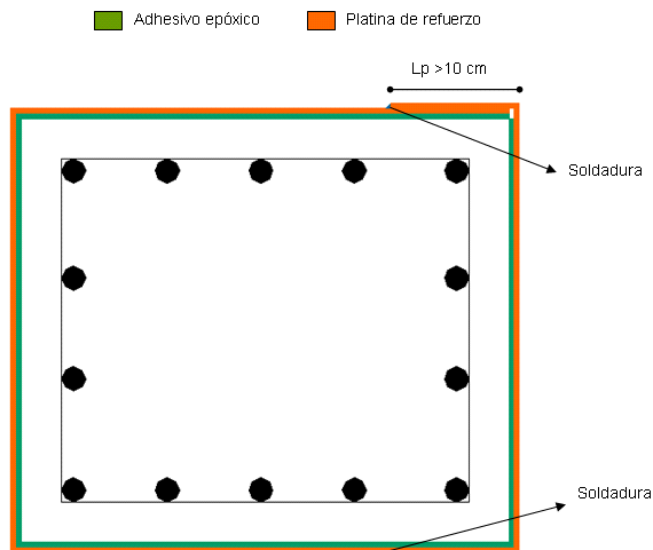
Esquema ilustrativo para el reforzamiento de vigas a cortante con platinas metálicas
